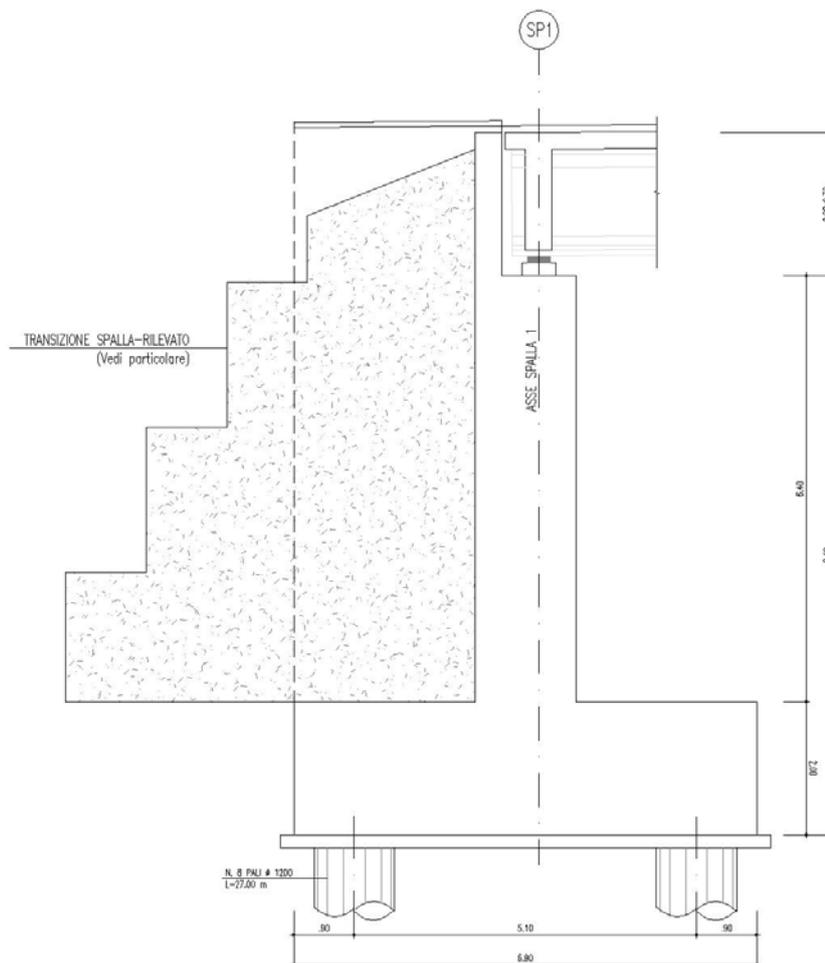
Sezione longitudinale della spalla 1.
